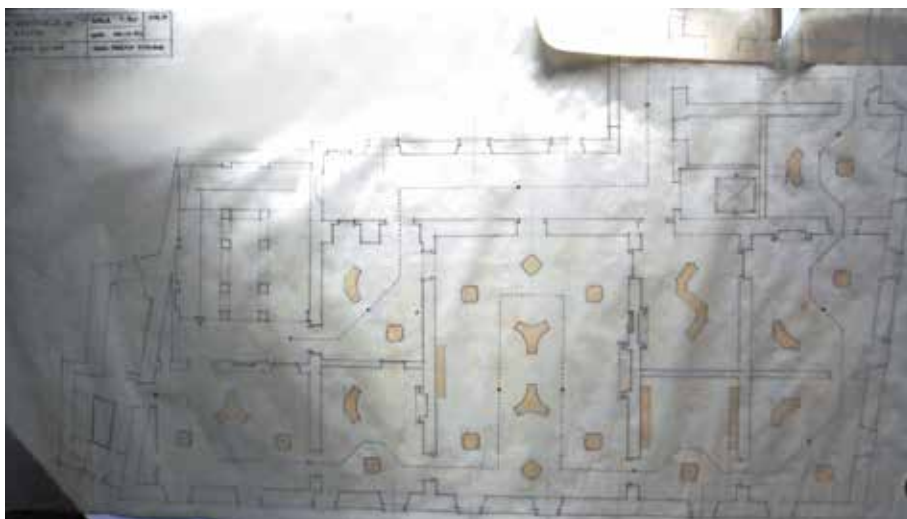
Il primo progetto di sistemazione del piano terra di Palazzo Ferretti da parte di Franco Minissi, nel 1956. (Archivio Centrale dello Stato)
